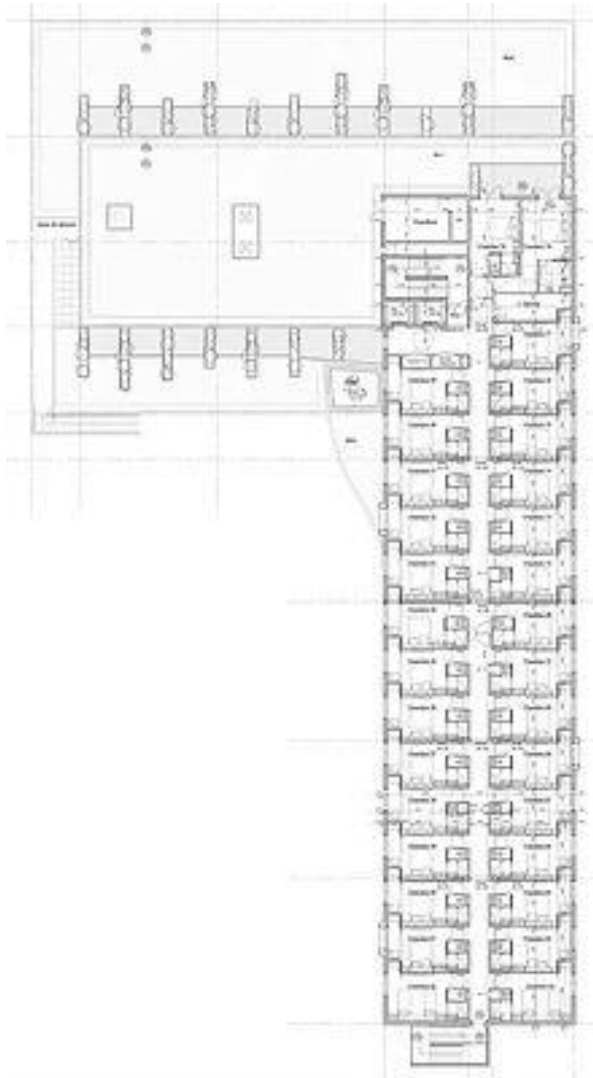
plan Du R+2 du centre de thalassothérapie Donville-les-bains
